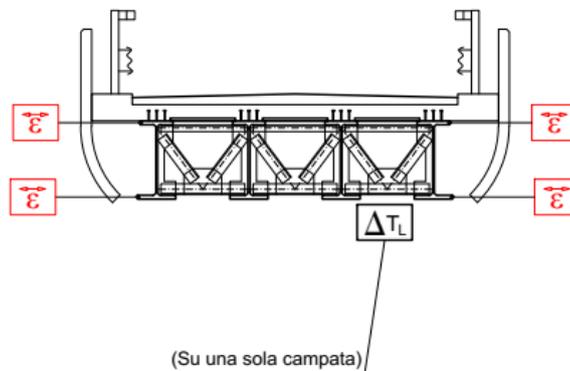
Ubicazione sensori su impalcato sezione a 3 travi (sezione trasversale viadotto MdP)
